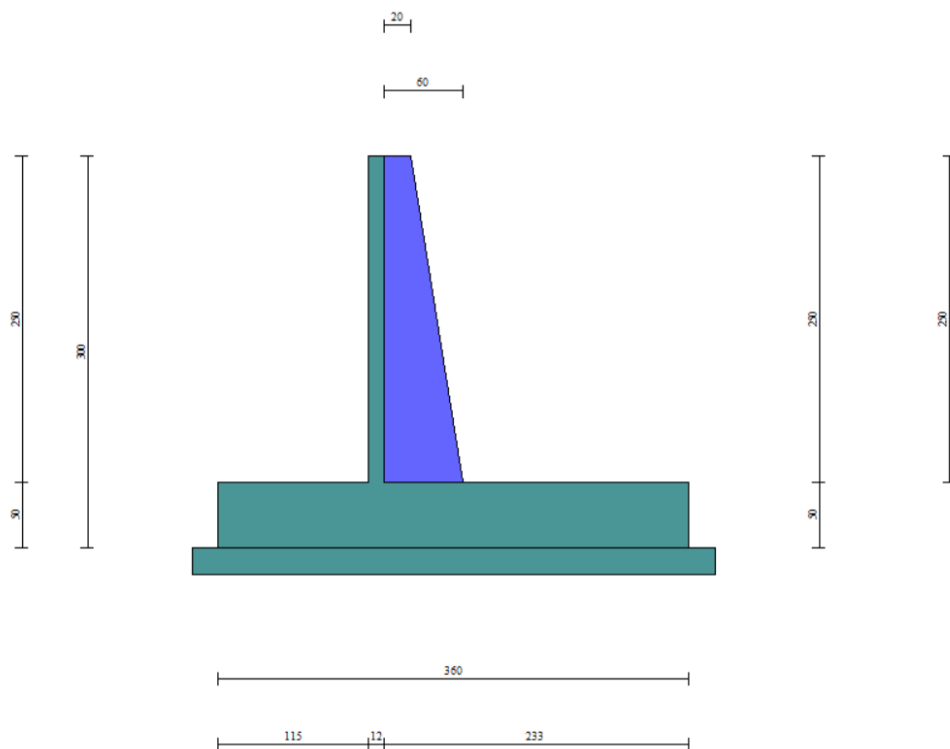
Geometria dei MURI DI SOTTOSCARPA - FONDAZIONE DIRETTA - TIPO 2
